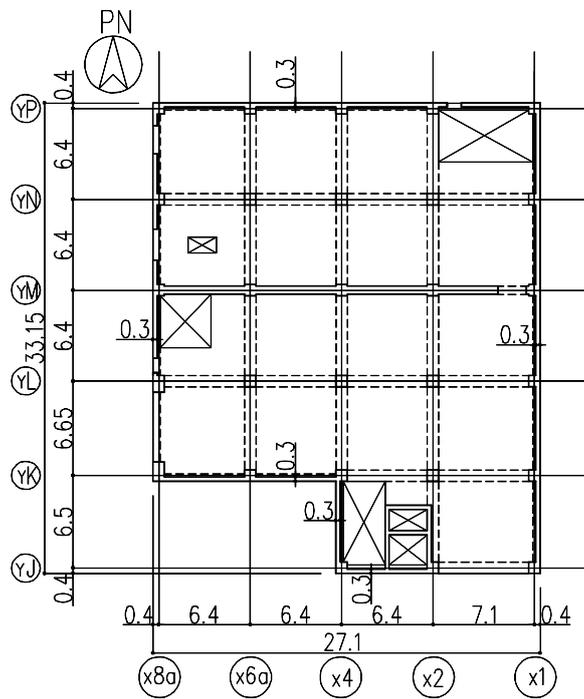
地上1階平面図 (G.L. +0.3) (单位 : m)
